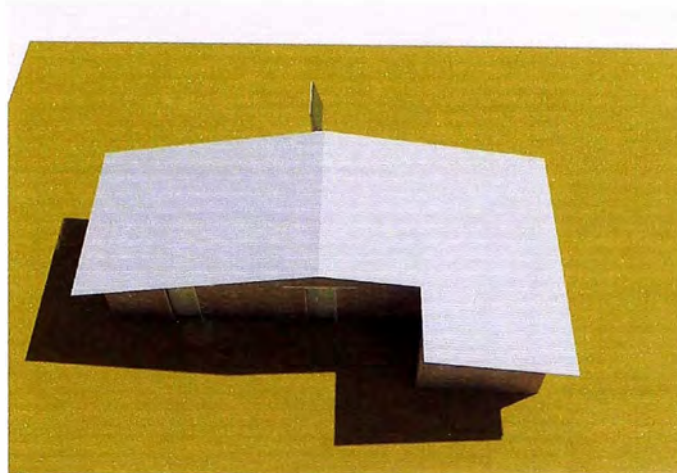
Plano arquitectónico – Vista en planta de la vivienda rural típica de la zona
